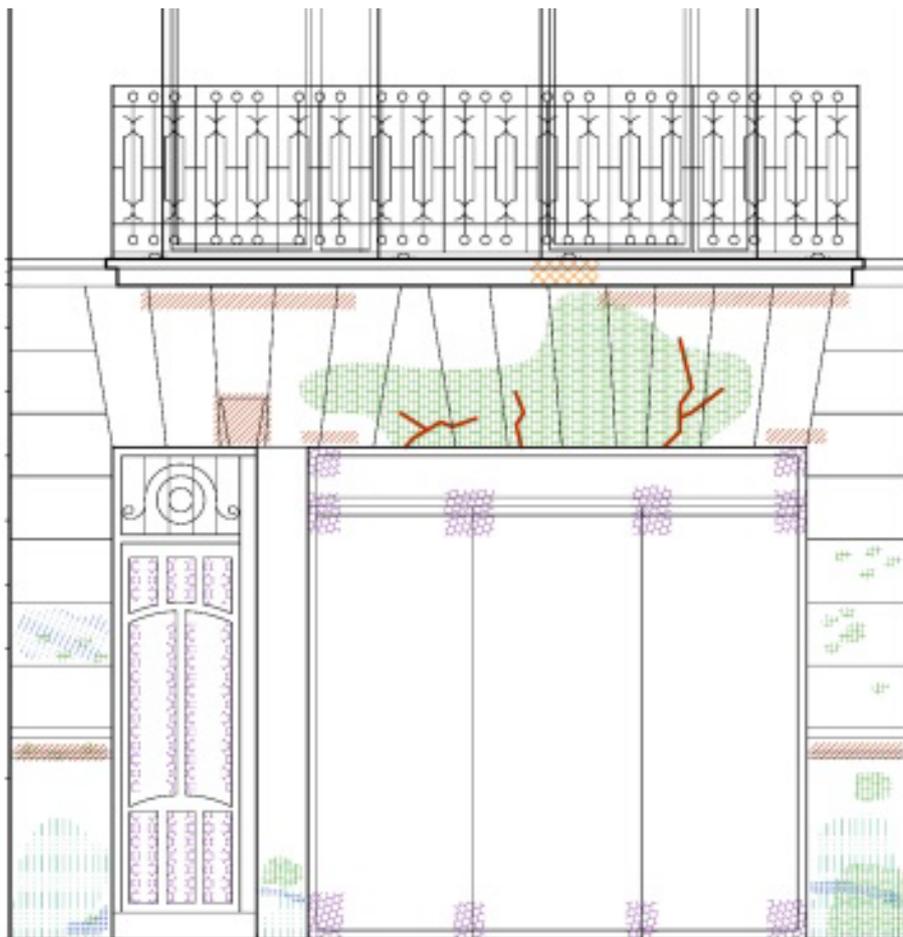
Plano patologías fachada principal (Plano nº 8, anexo II). Fuente propia.
